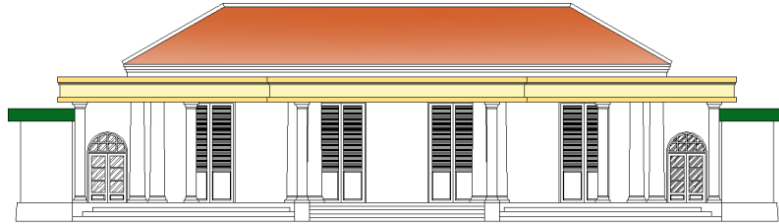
Kolom fasade dan ruang dalam bangunan utama eks rumah Dinas Residen Kediri
